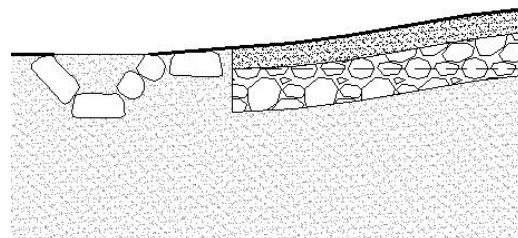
Sezione tipo cunetta longitudinale lastricata
